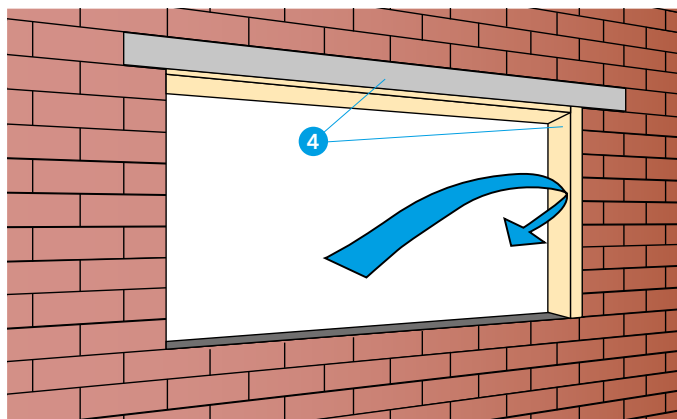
Detail A - příklad provedení obkladu deskou PROMASIL®-KP v místě tepelného mostu
